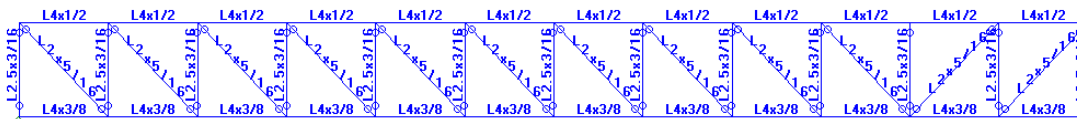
Perfis viga treliçada TIPO A – Tesoura banzo reto
